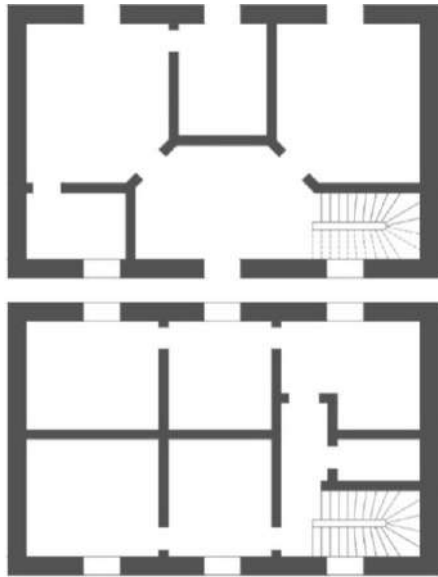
Planta-tipo para uma estação de 4ª classe. Piso térreo e 1º piso. 1861.²⁶⁸
